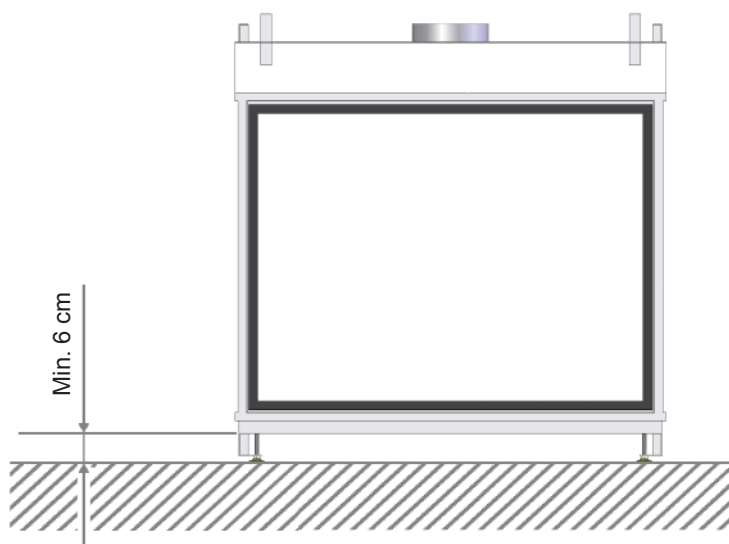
Deve essere mantenuto uno spazio di almeno 6 cm tra la base dell'apparecchio e il pavimento.
